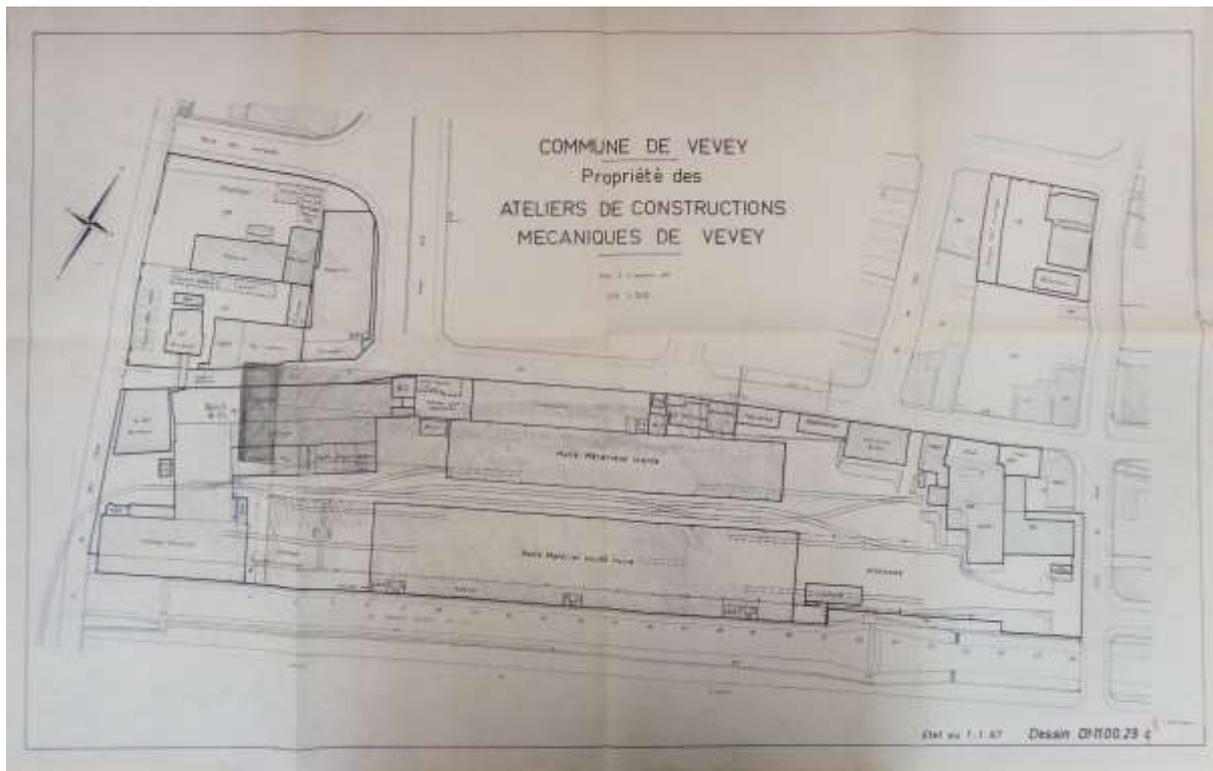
Plan général du site des ACMV, 1<sup>er</sup> janvier 1967 (ACV, PP861/25/2).
